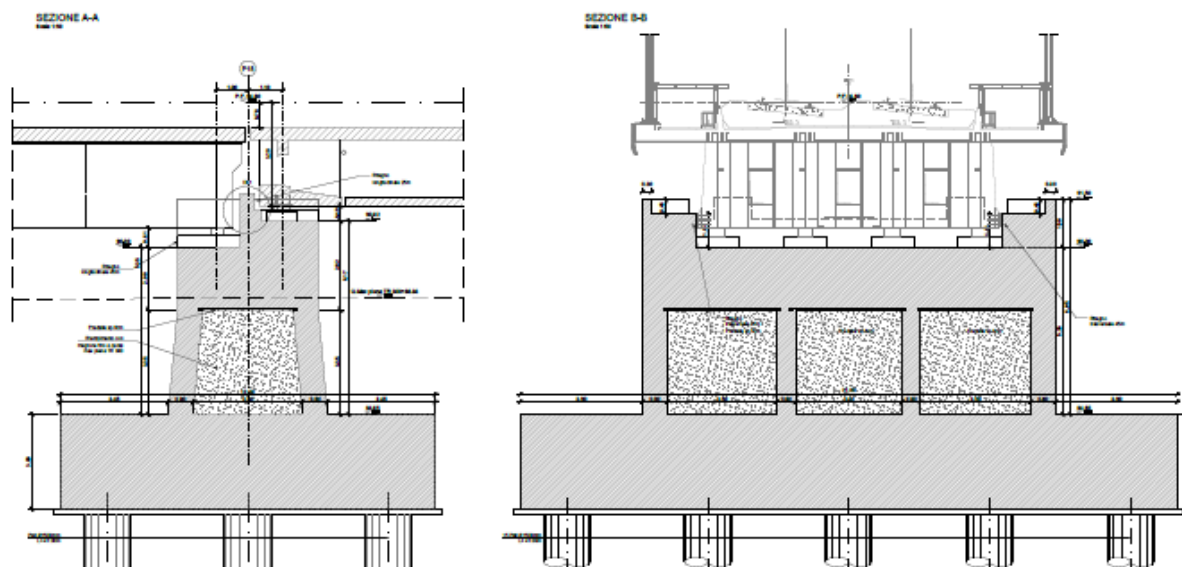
Sezione in direzione trasversale e longitudinale rispetto all'asse del viadotto P15
